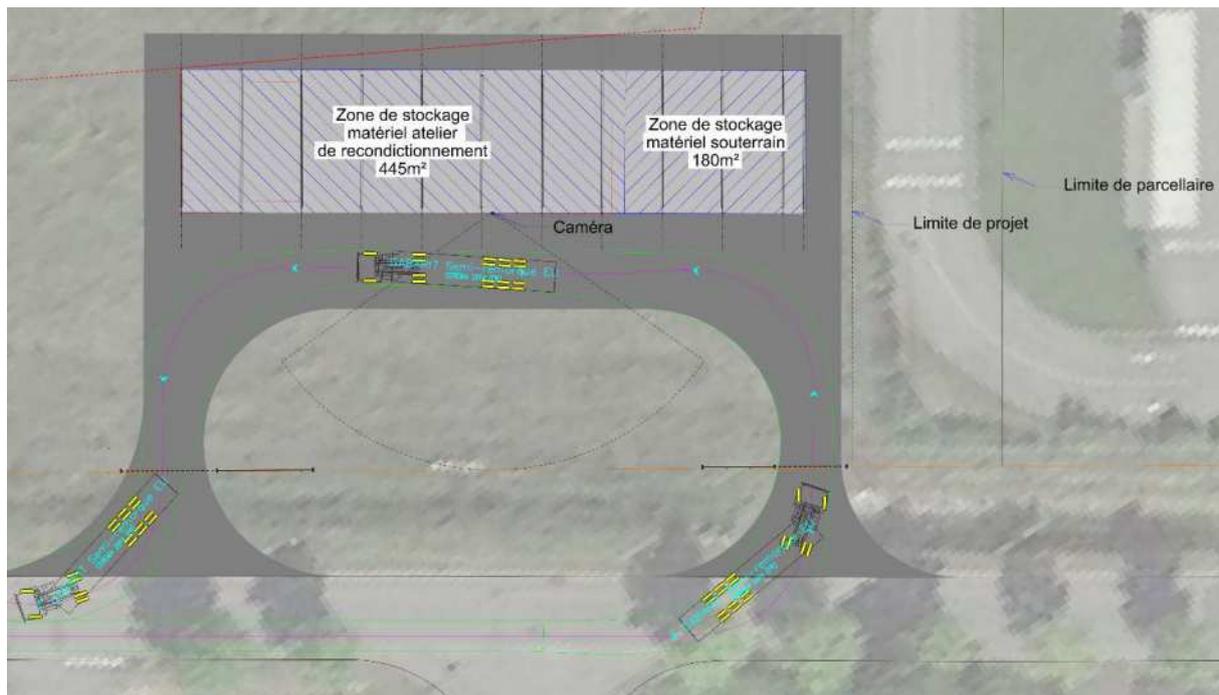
Extrait des plans 2D de la zone extérieure de stockage implantée sur la parcelle n°409
